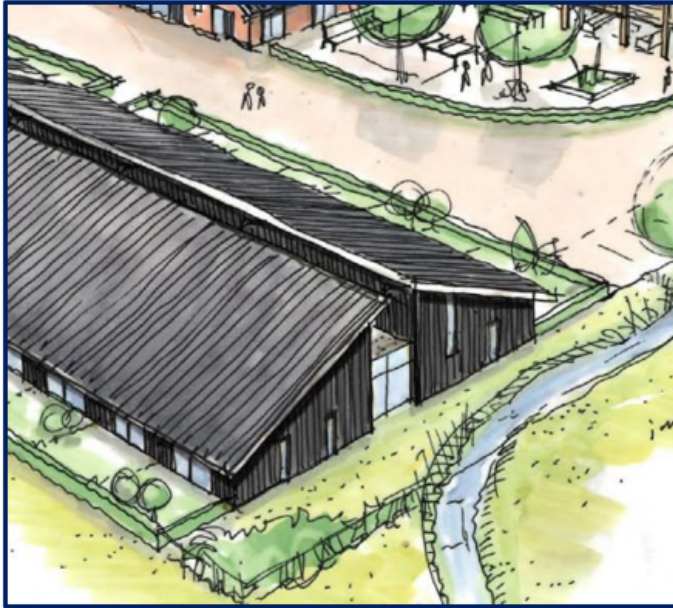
Toekomstige situatie erfinrichting (bron: Building Design Architectuur)
